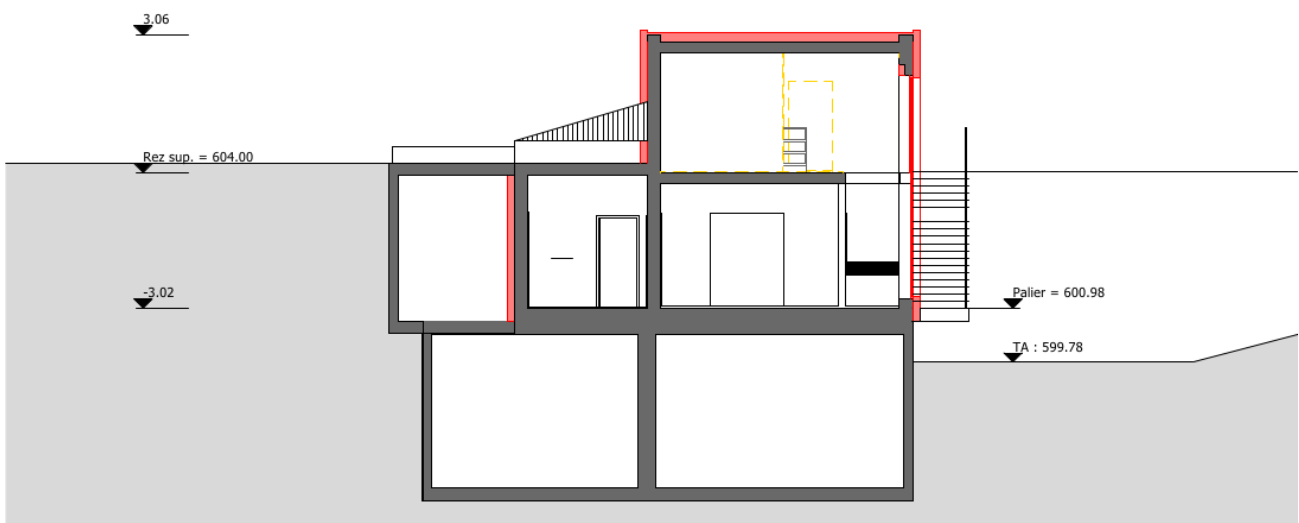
Plan de la coupe H du bâtiment existant au nord-est de la zone de projet. Extrait de [1].
